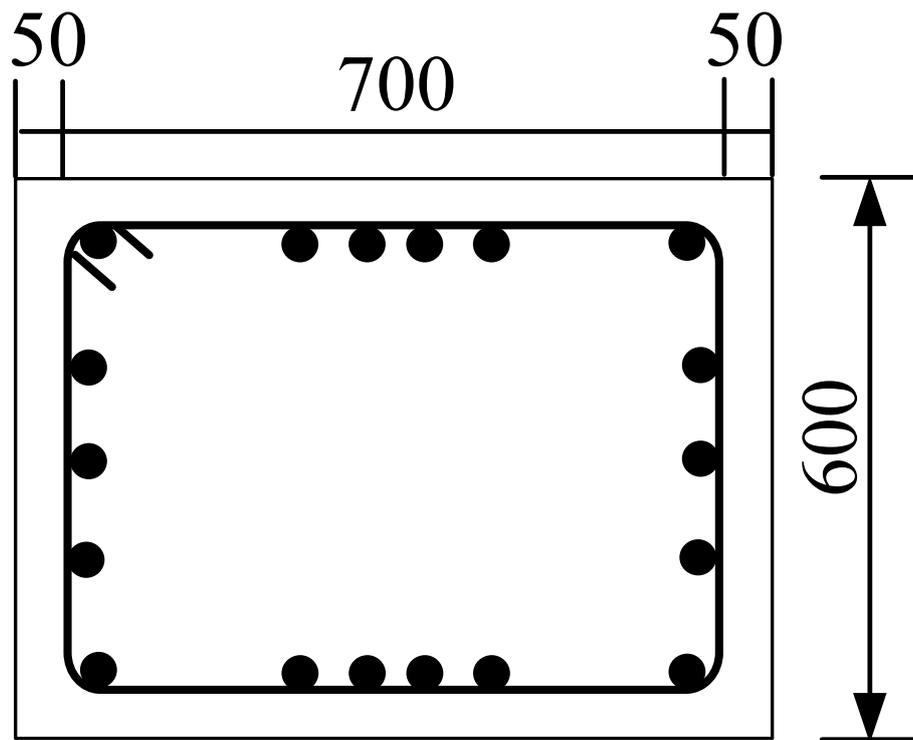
梁試體基礎之斷面圖(單位：mm)
